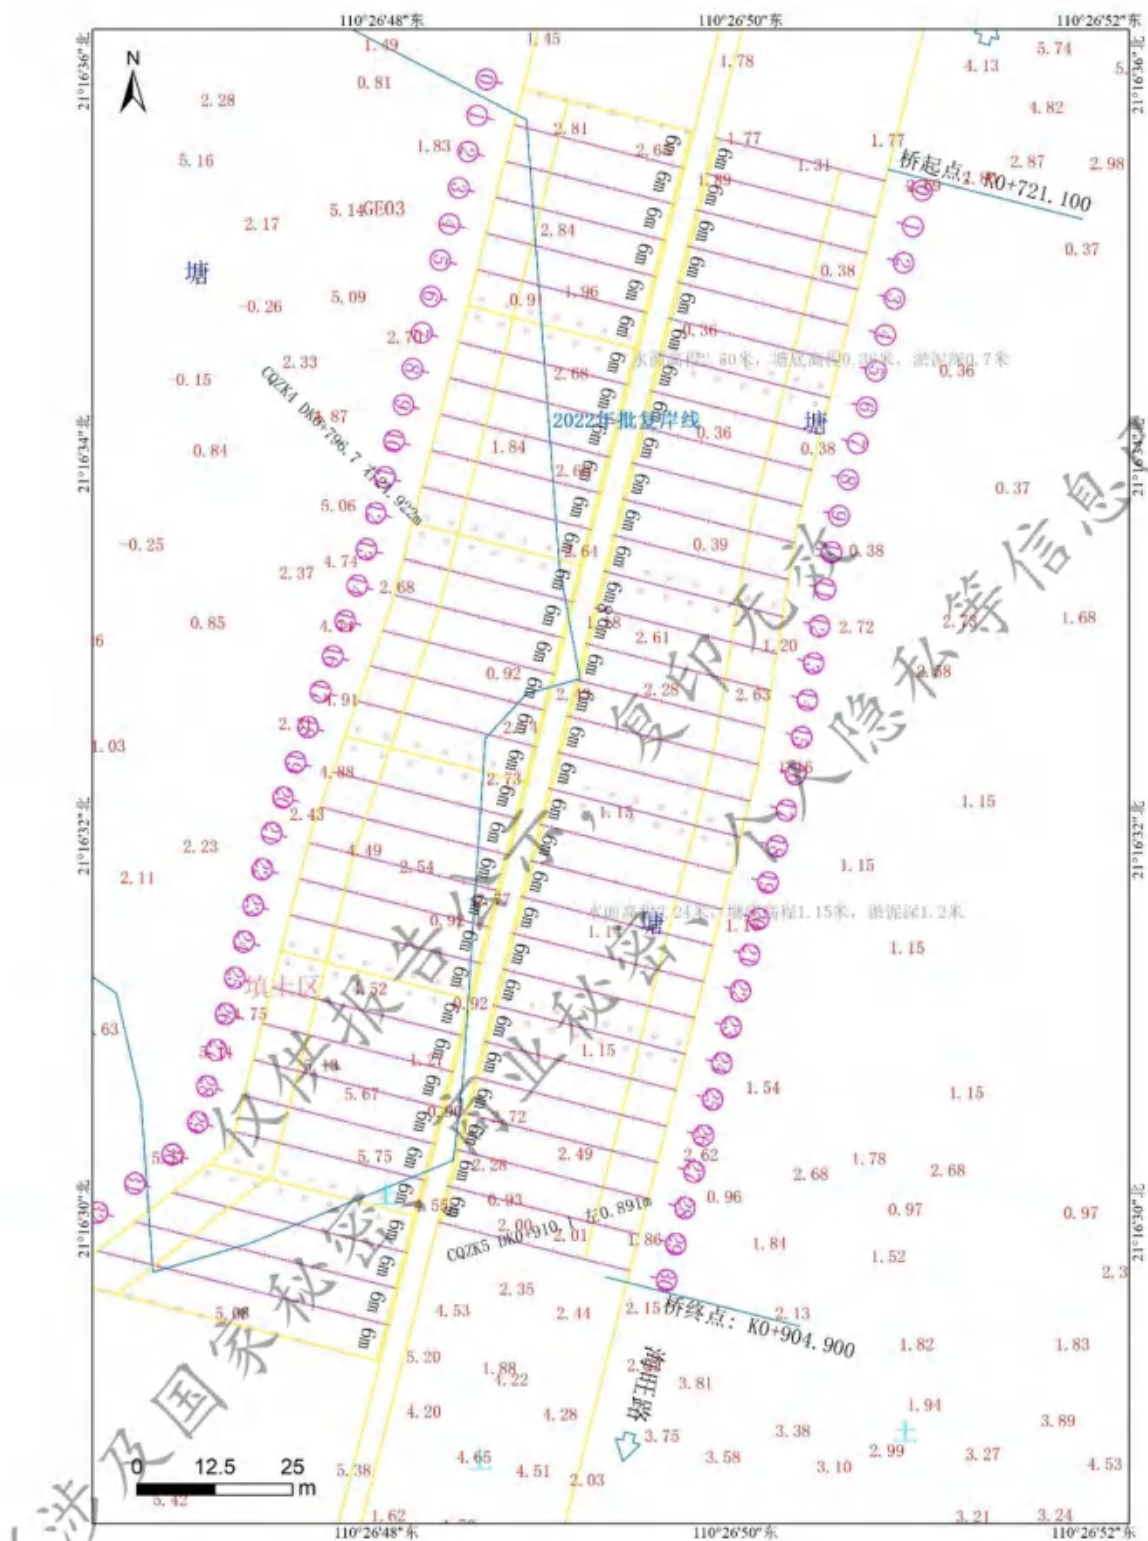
东旺大道桥梁总平面布置图 (1)
